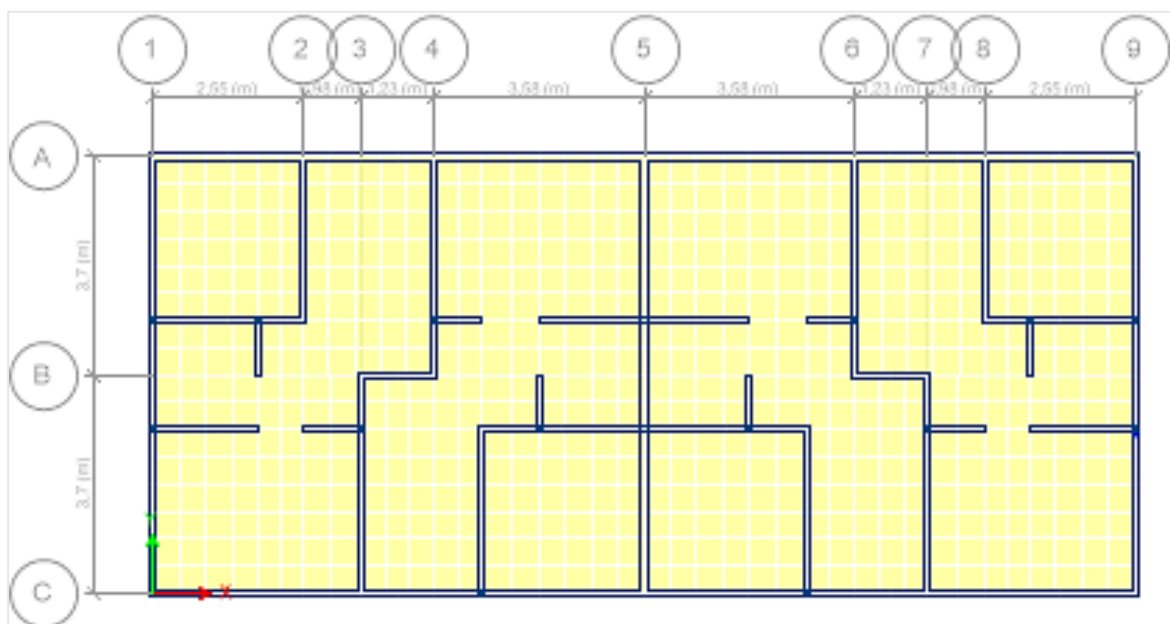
Muros Segunda planta de Conjunto de casas C82. Nivel N+4,90
